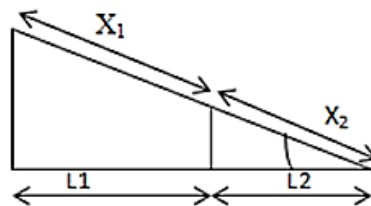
schéma de la toiture reposant sur le poteau le plus sollicité.
